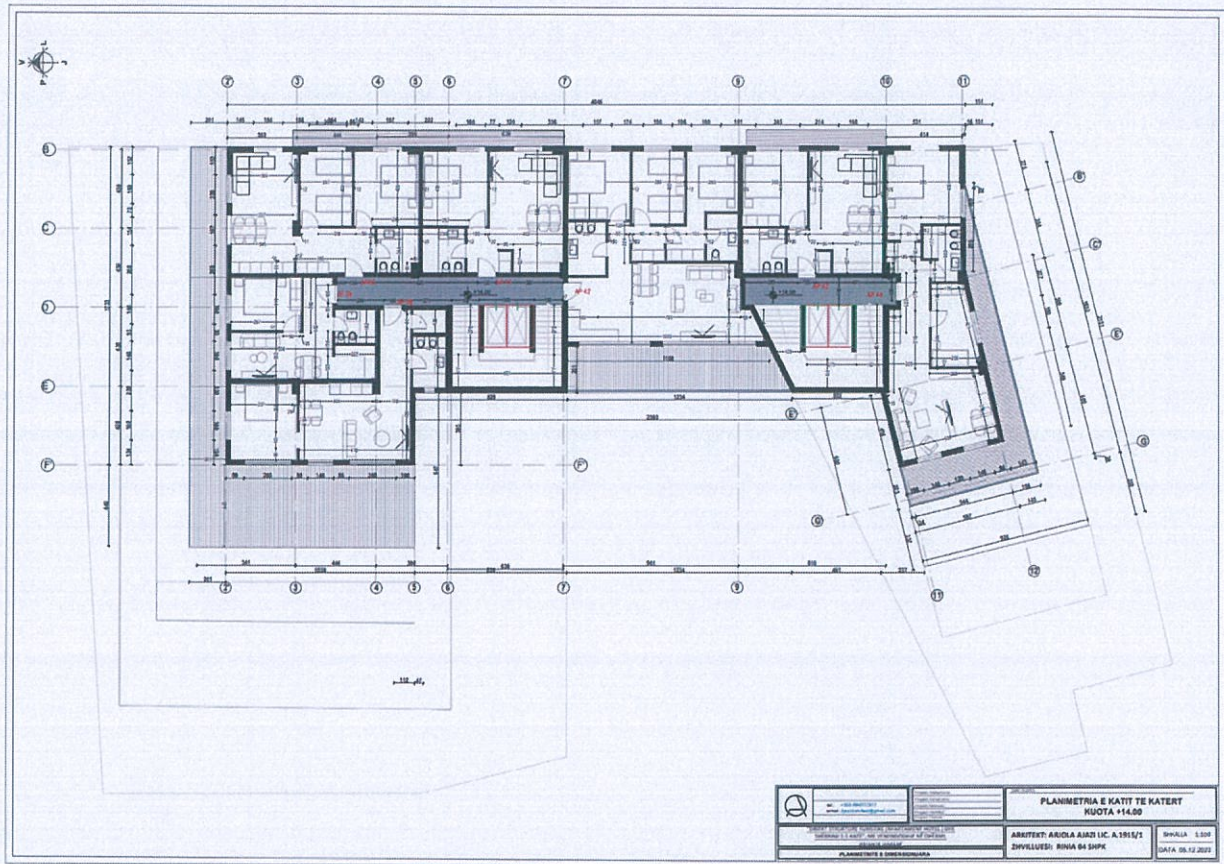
Planimetri e katit te katert (kuota 14.00)
